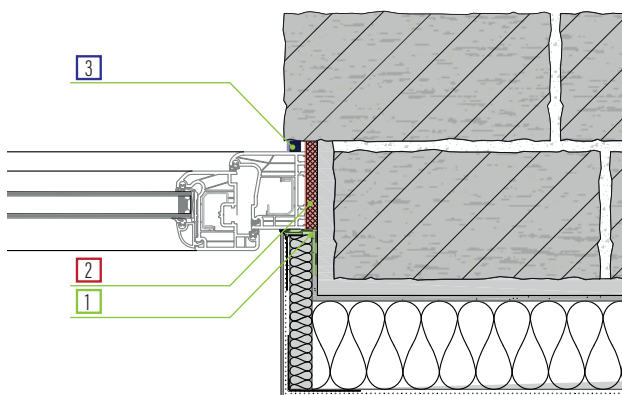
Laibungsdämmung – Horizontalschnitt (rechts). Mittig im Mauerwerk positionierter Fensterrahmen.
